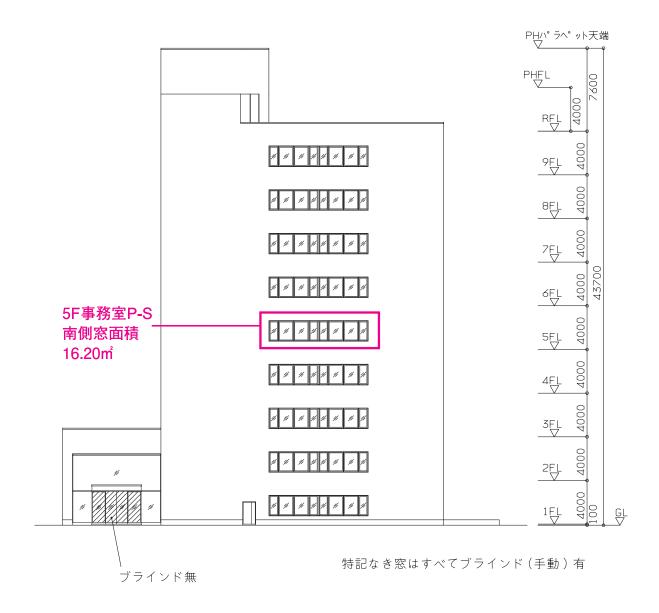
意匠図 立面図 (東) (図面 - 意 -7)
